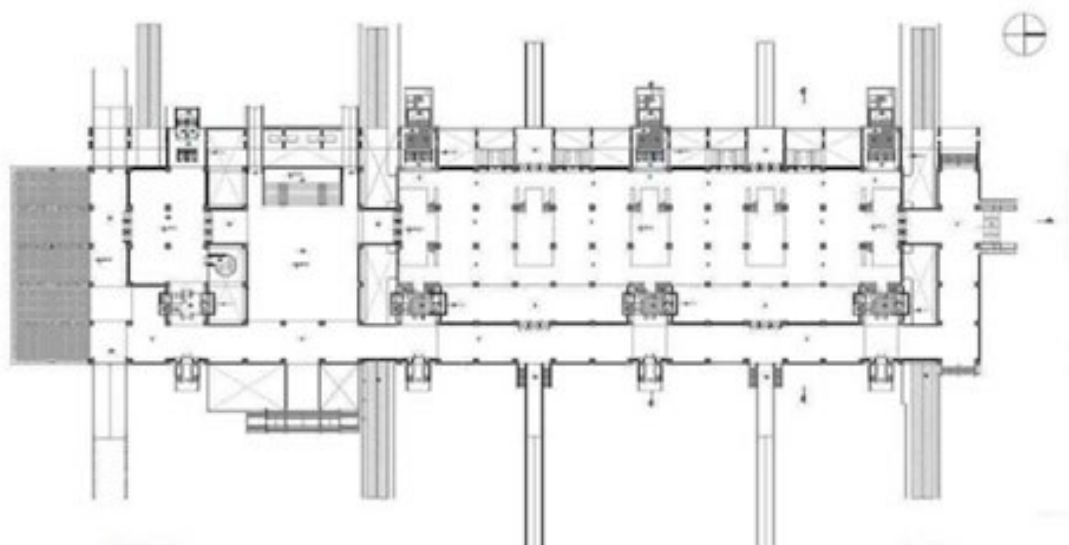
Edificio Centro Cívico-Planta Baja. Fuente: Dirección de Planeamiento y Desarrollo Urbano.
